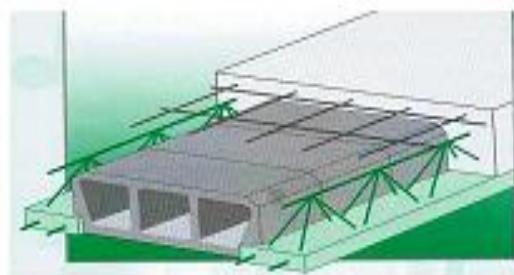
Coupe transversale d'un plancher en corps creux.
